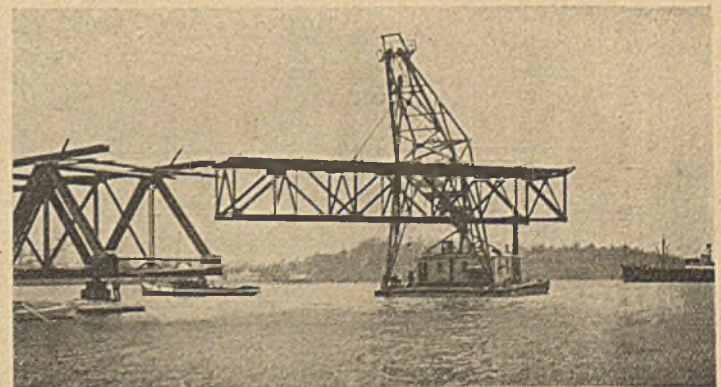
Einbau eines eingehängten Trägers mit dem Schwimmkran.
